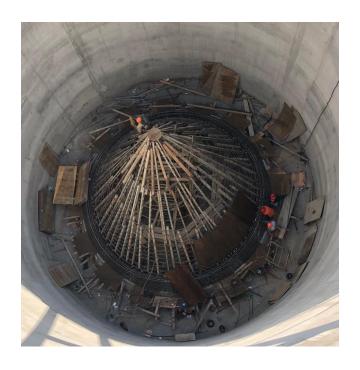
Vista superior de encofrado de cono de concreto reforzado.
